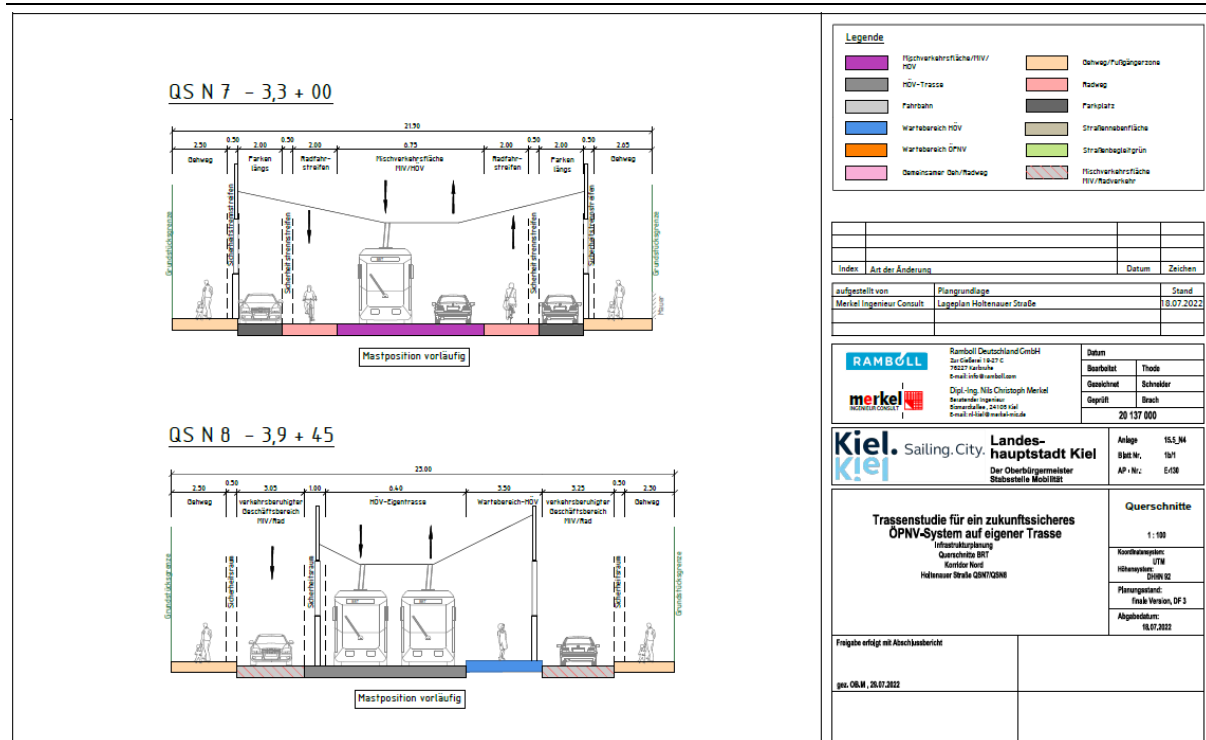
Beispielquerschnitte BRT Holtenauer Straße vor und nach Belvedere, Maßstab 1:100
